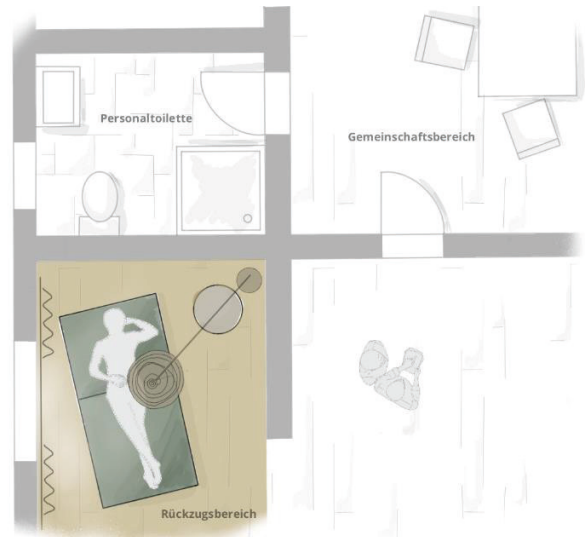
Grundriss einer möglichen Rückzugsecke/-nische in einer Notaufnahme
